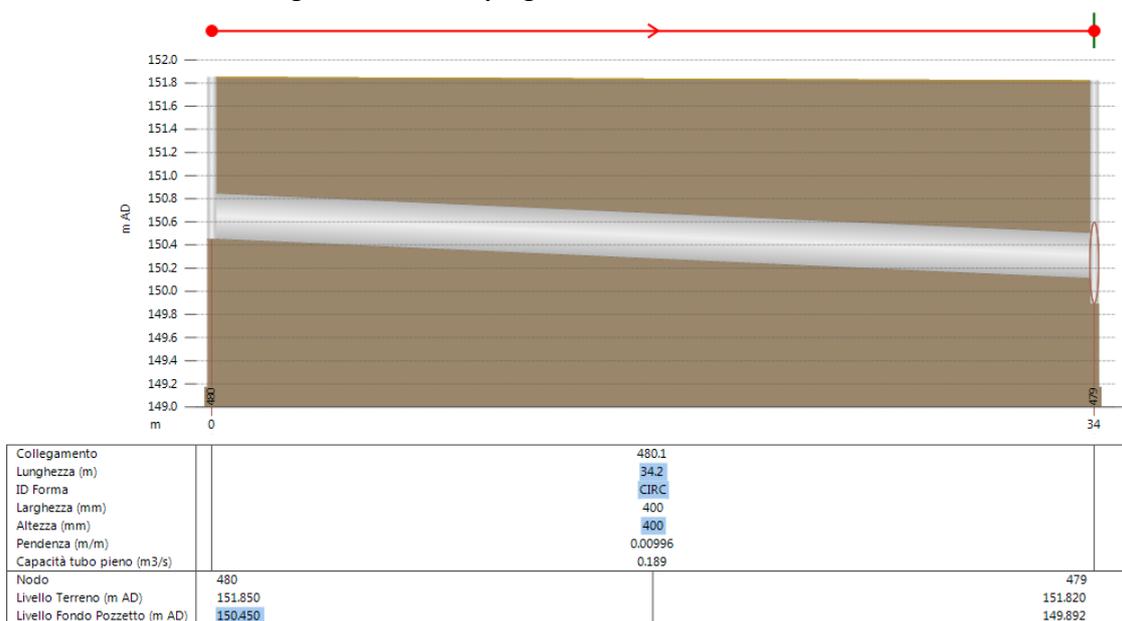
Profilo di progetto, raccordo laterale tratto da camera 480 a camera 479
